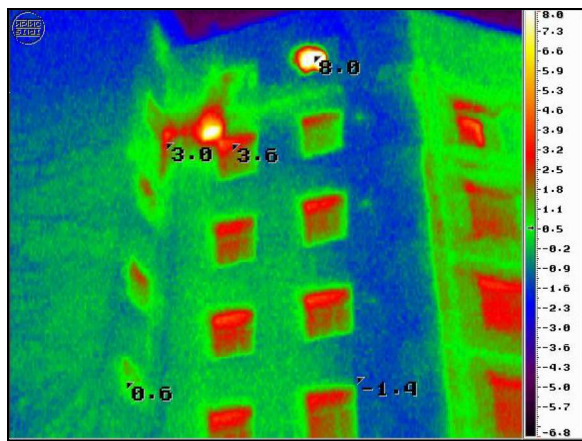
Тепловые потери через отверстие воздушной вентиляции.
